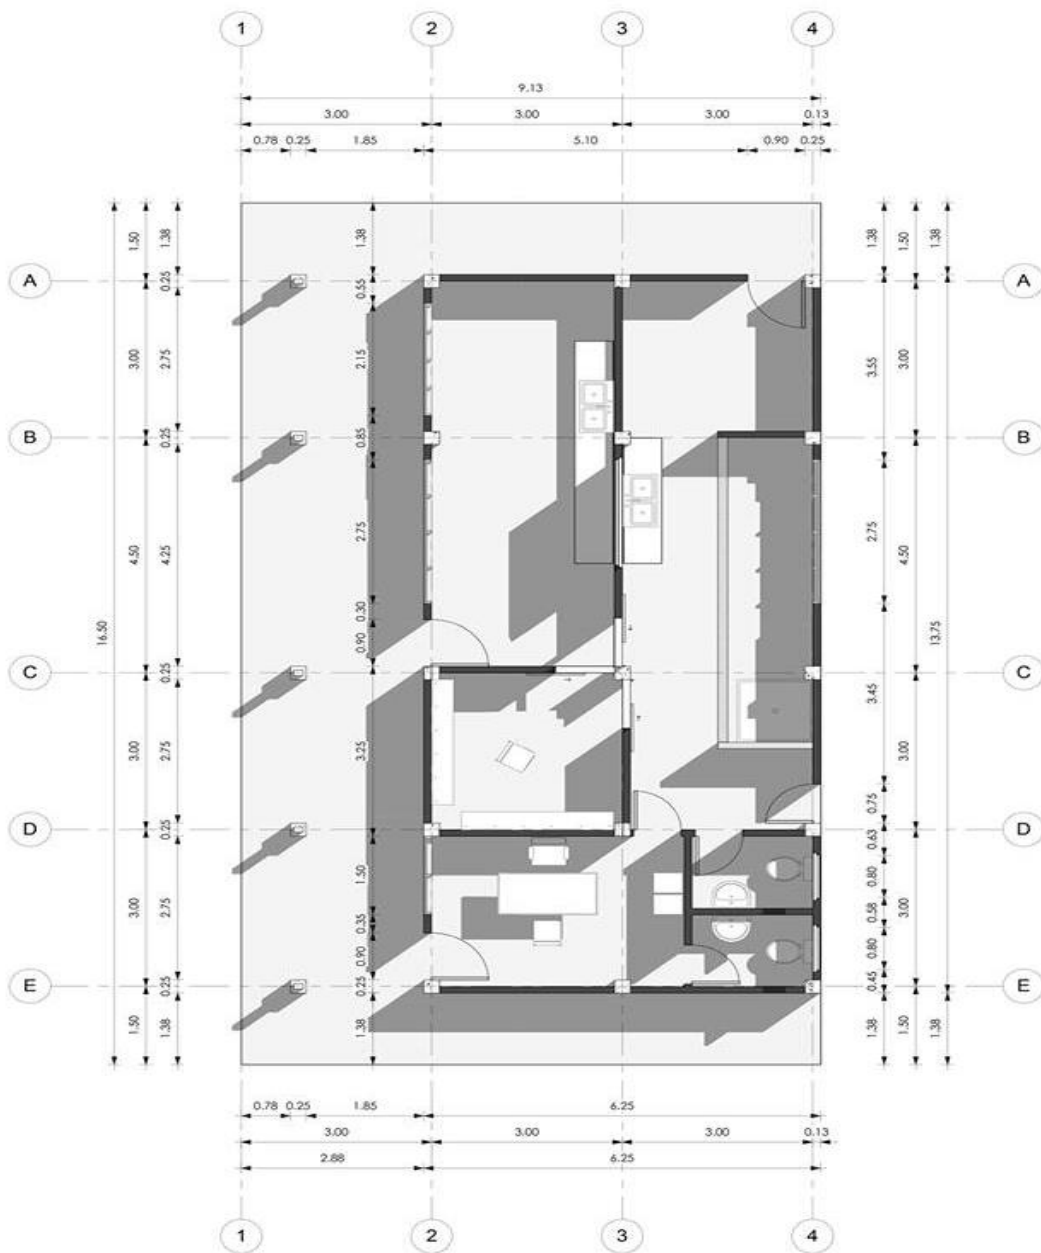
Plano acotado de la planta de extracción del aceite esencial.
